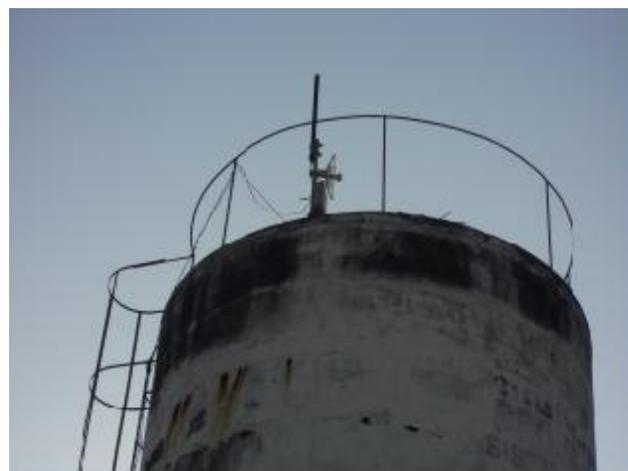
REL-05: guarda corpo da laje de cobertura em processo de corrosão.
